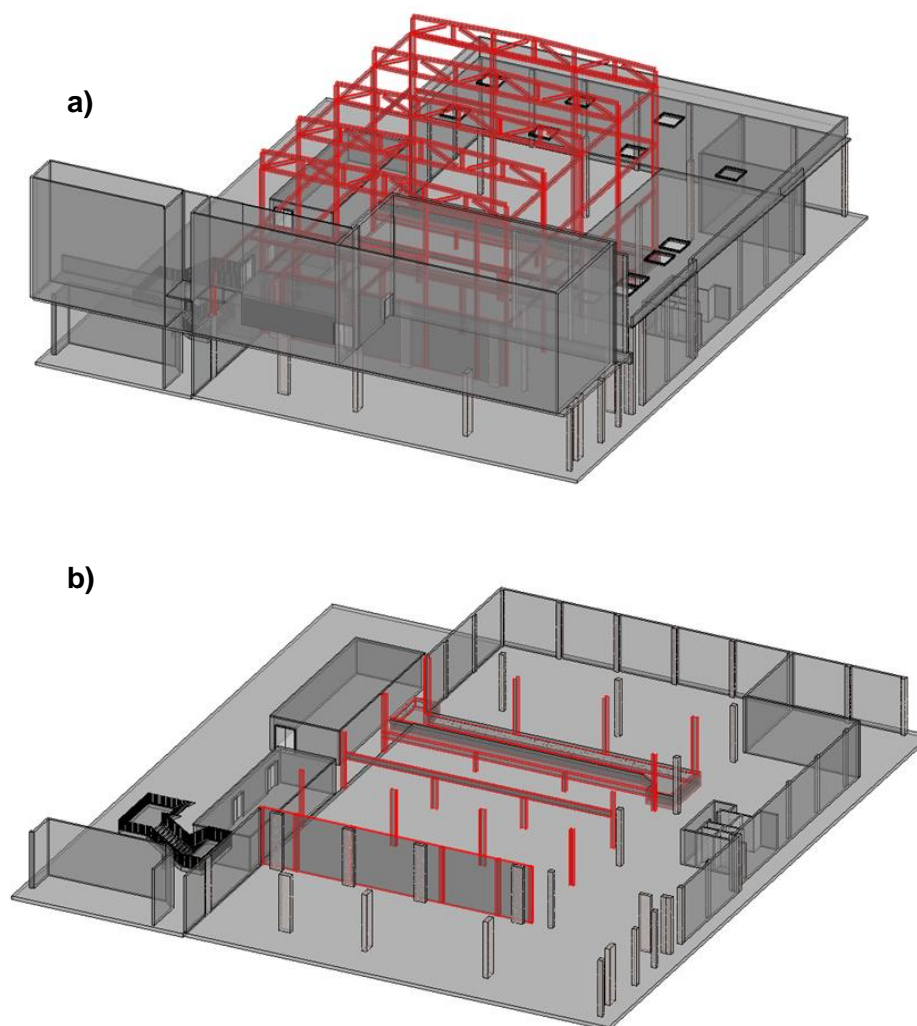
Construção nova alçado Norte; a) Vista alçado este; b) Corte Transversal
